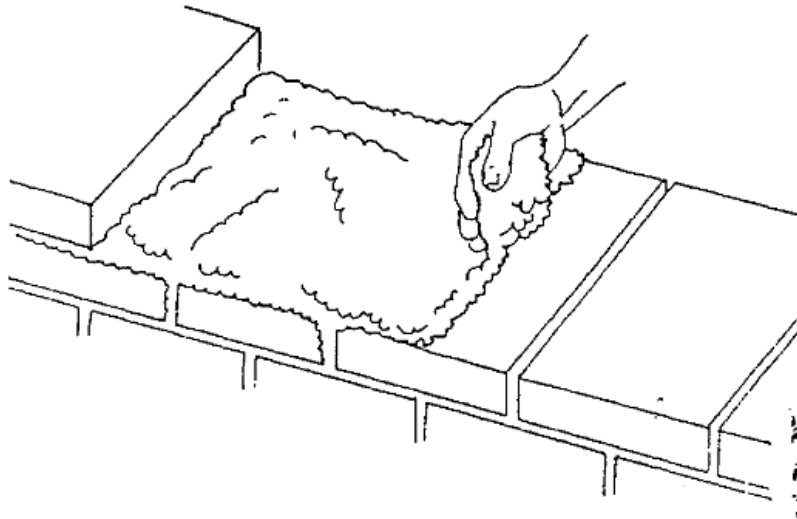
Unión de Adobes (Fig.: Manual para construcción con adobe 1993)
